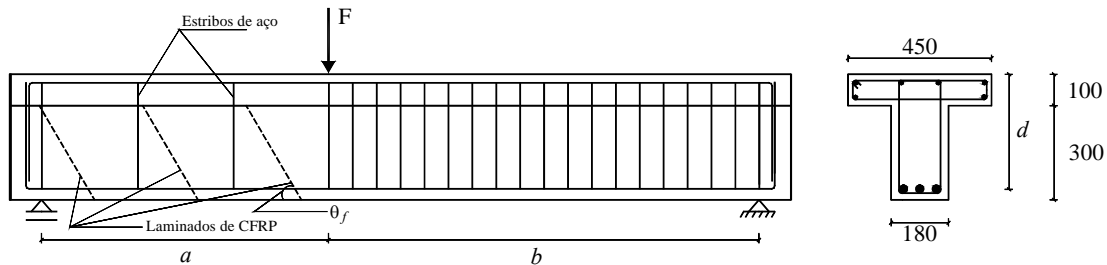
Dados gerais sobre as vigas ensaiadas (dimensões em mm).
